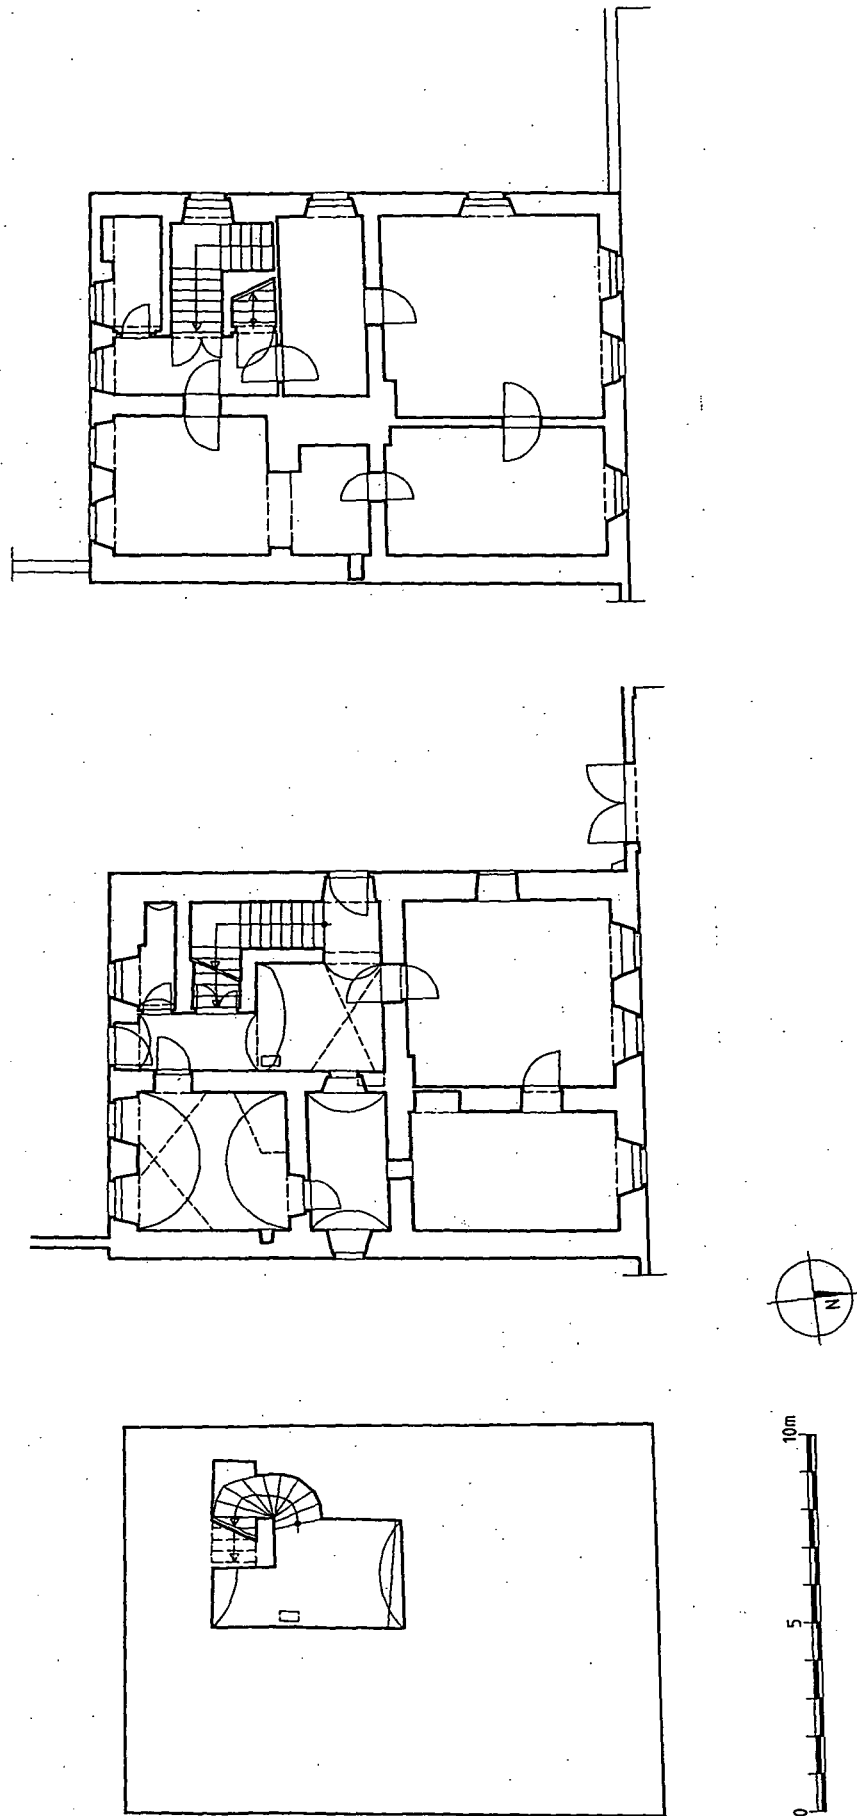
Keplerstraße 7/I – Grundrisse Keller, Erdgeschoss, Obergeschoss (1:200).
